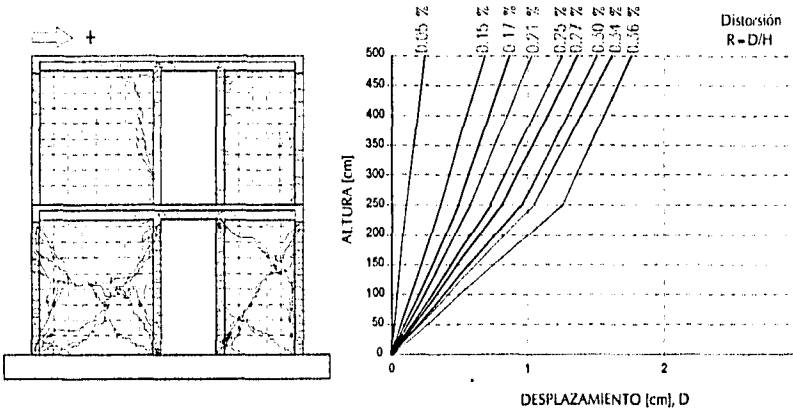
Patrón Final de Agrietamiento para el Muro Norte
